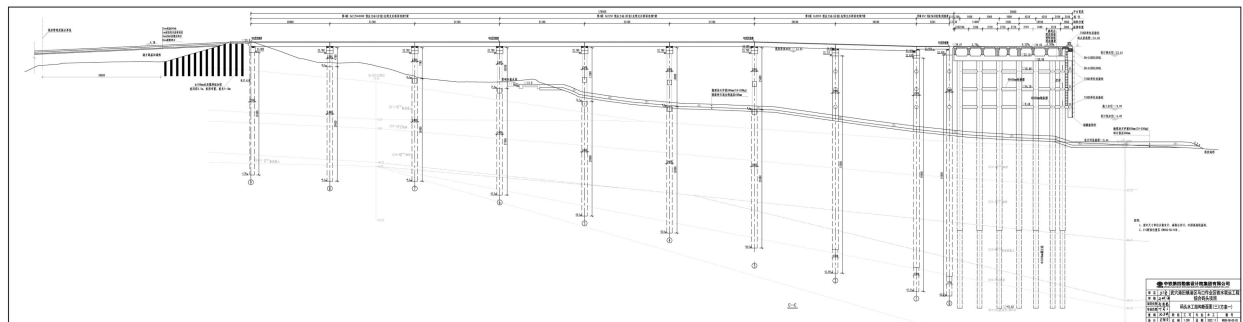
水工结构断面图（三）（方案一 推荐方案）
